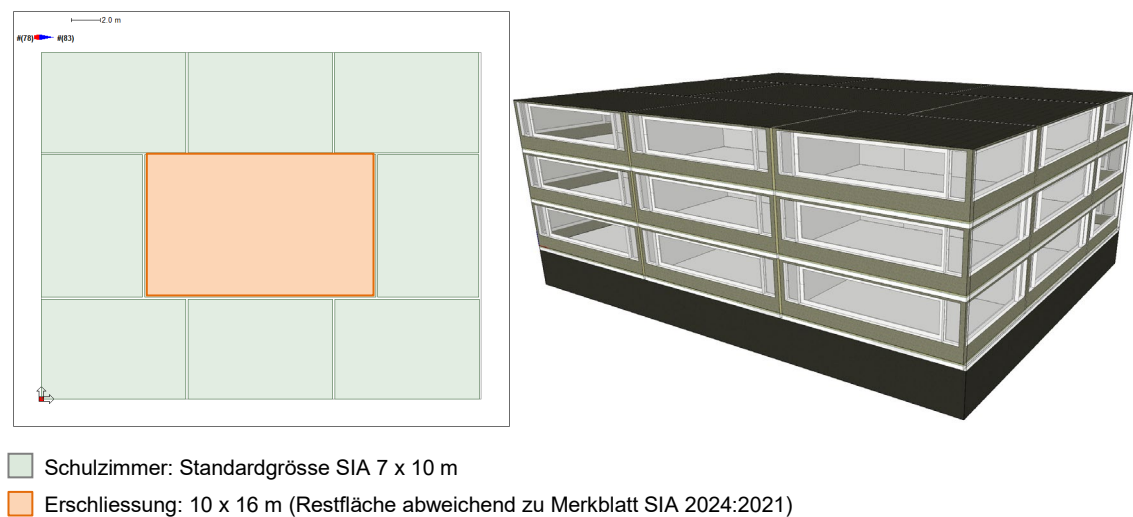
Grundriss mit Zoneneinteilung (links) und 3-D-Darstellung (rechts) des Schulgebäudes.
